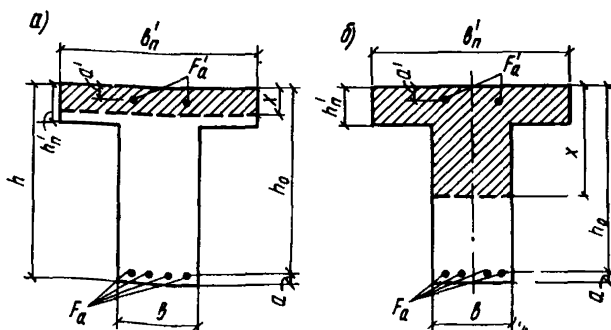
Форма сжатой зоны в сечении изгибаемого железобетонного элемента с полкой в сжатой зоне
